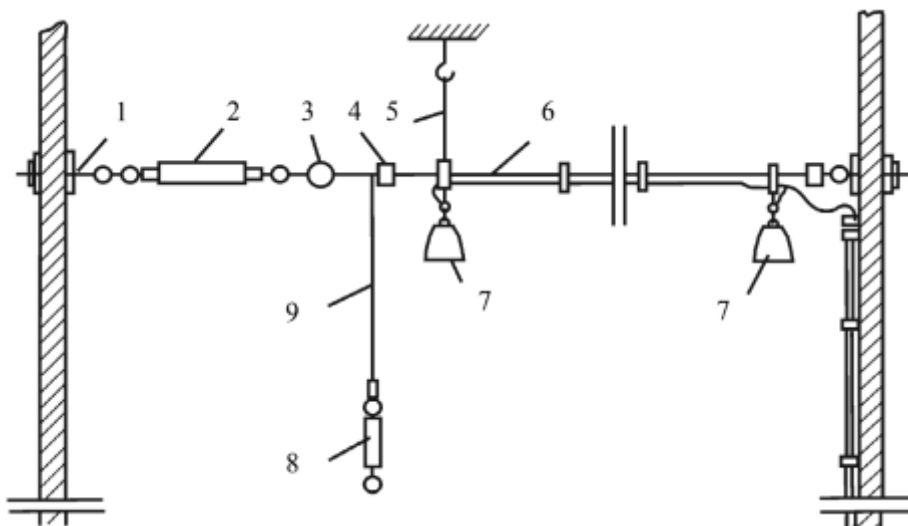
Прокладка кабелів на будівельних конструкціях
